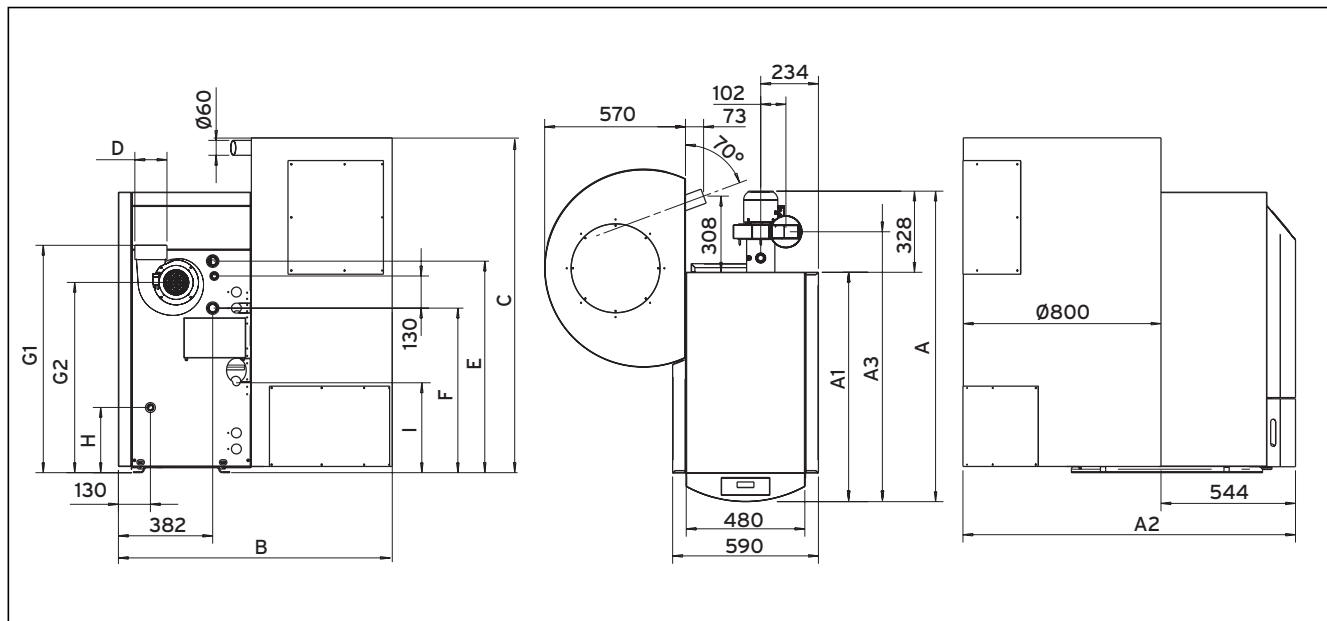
Abmessungen: Pelletkessel mit Saugaustragung oder Handbeschickung
